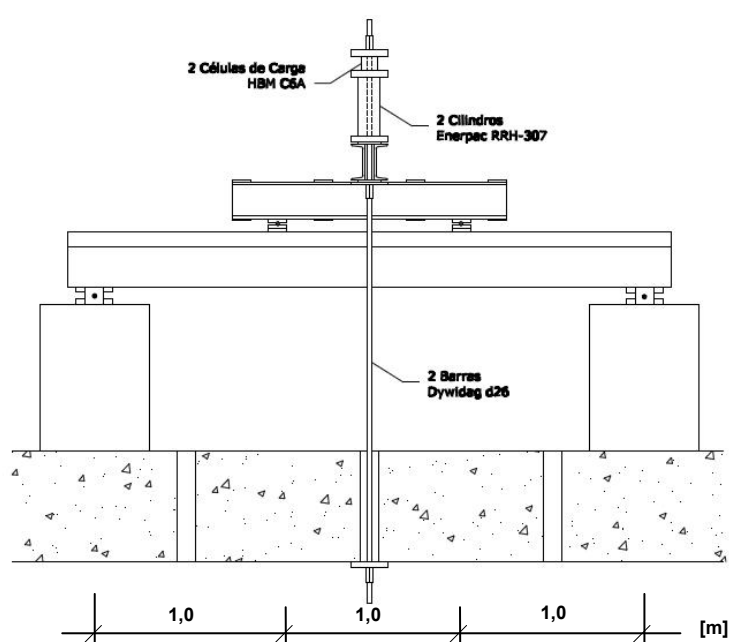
Alçado longitudinal do sistema de ensaio
